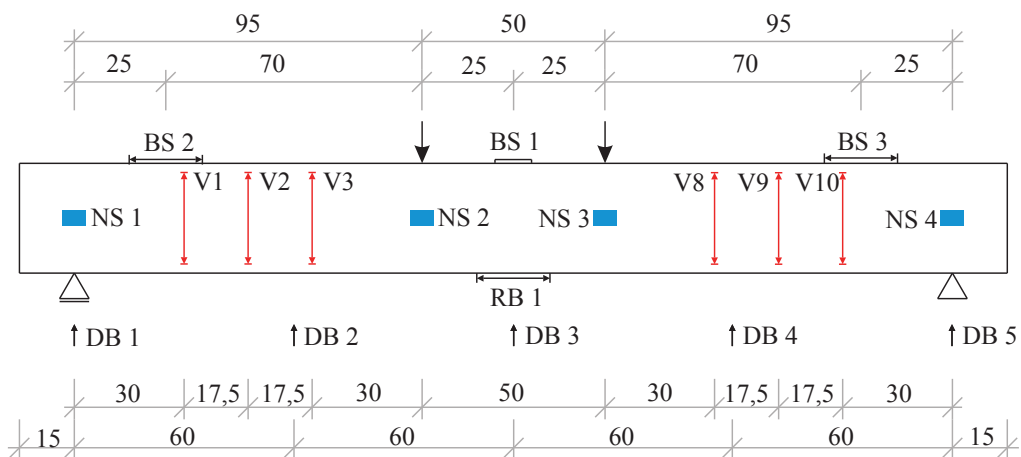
Bewehrungsführung und Anordnung der Messtechnik für Balken BQ02
